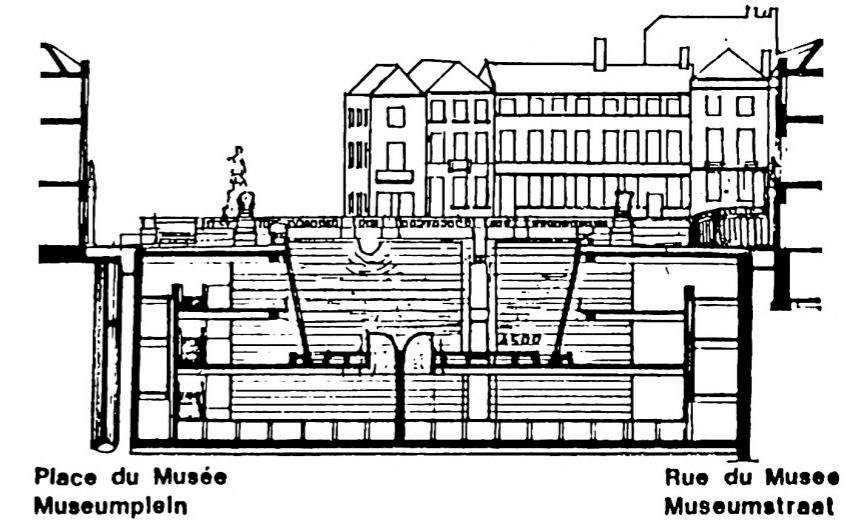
Coupe longitudinale du musée d'Art moderne sous la place du Musée, traversant le lanterneau en demi-voutes, projet définitif.
